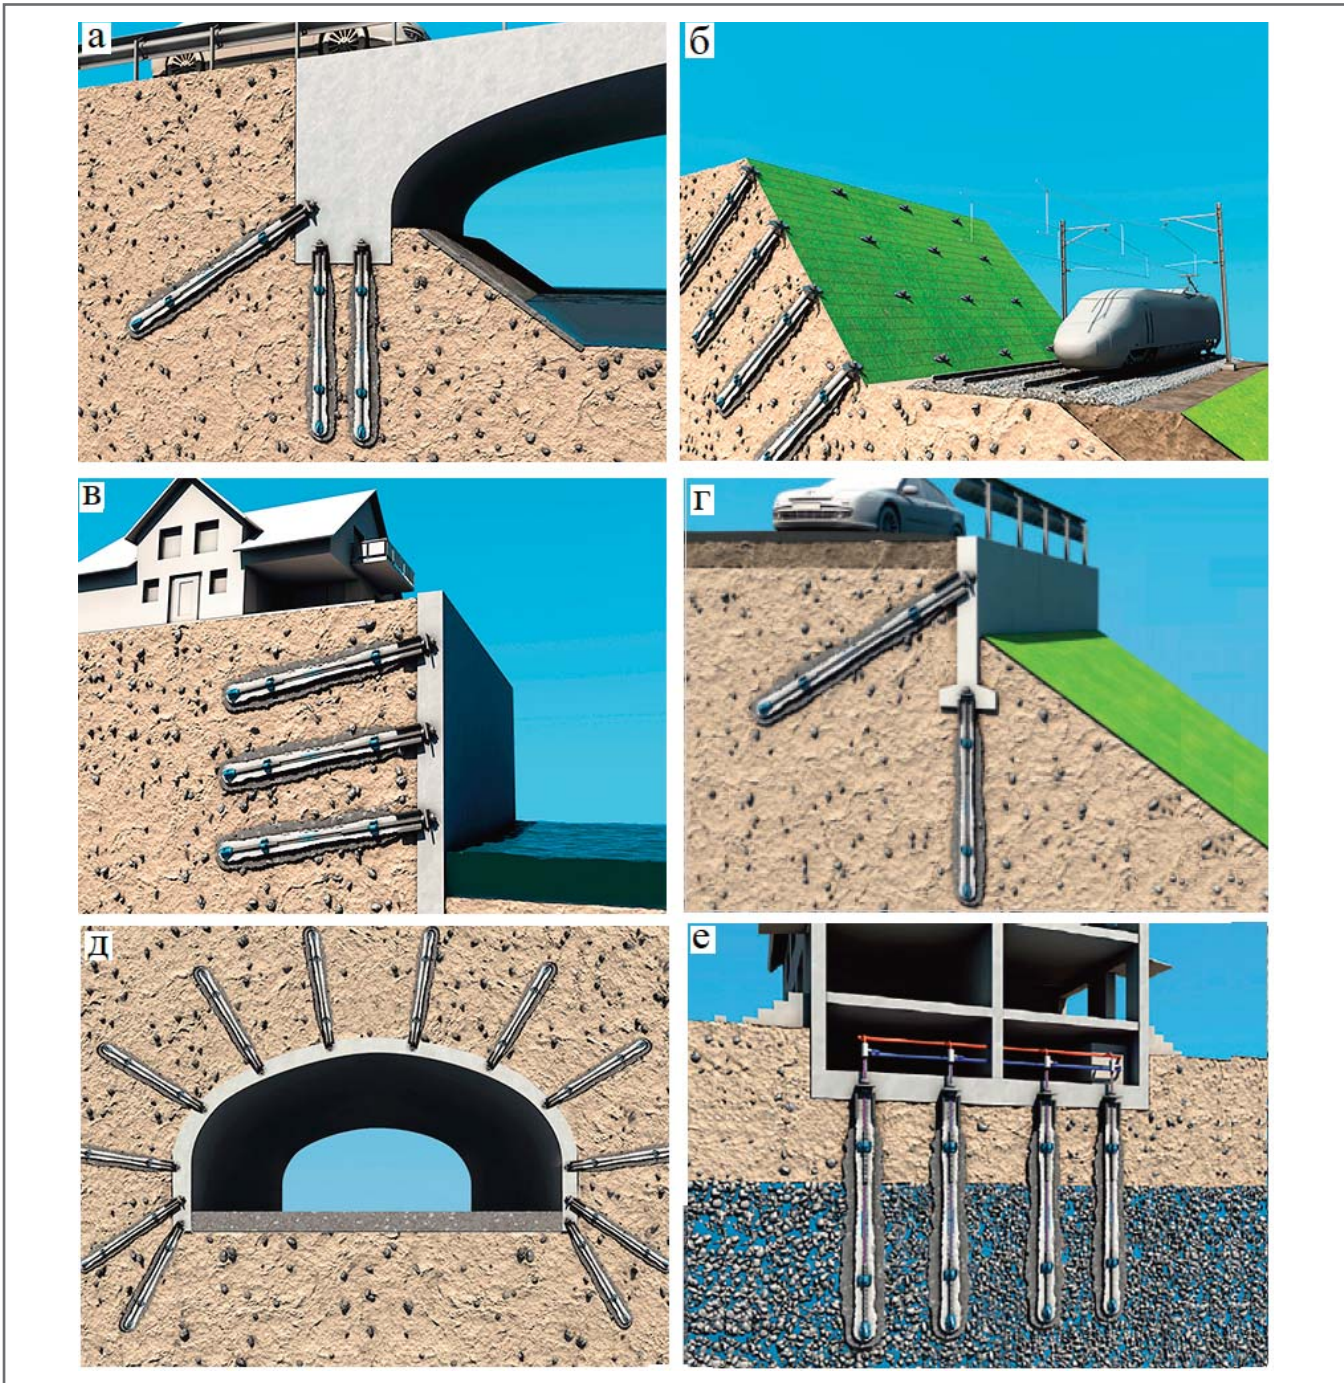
Примеры использования грунтовых буринъекционных анкеров для закрепления: а – устоев мостов; б – склонов и откосов, в том числе покрытых георешетками или др.; в, г – подпорных стенок; д – сводов и стен тоннелей; е – фундаментных плит зданий и сооружений, в том числе для противодействия их гидростатическому подъему при нахождении в обводненных грунтах (по [2])
